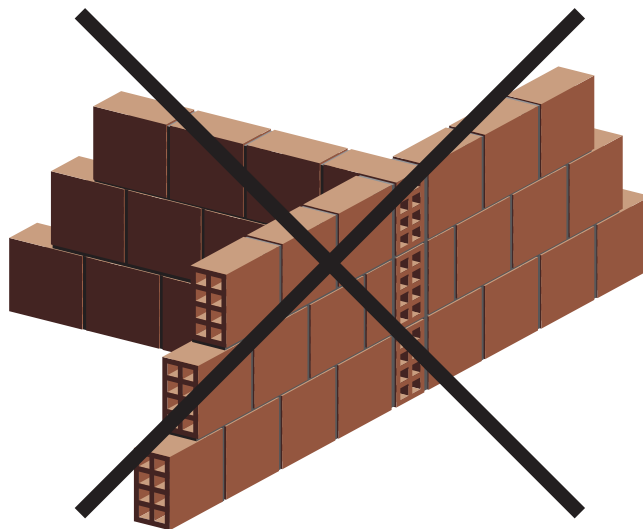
Juntas a prumo não recomendadas para as paredes de fachada
